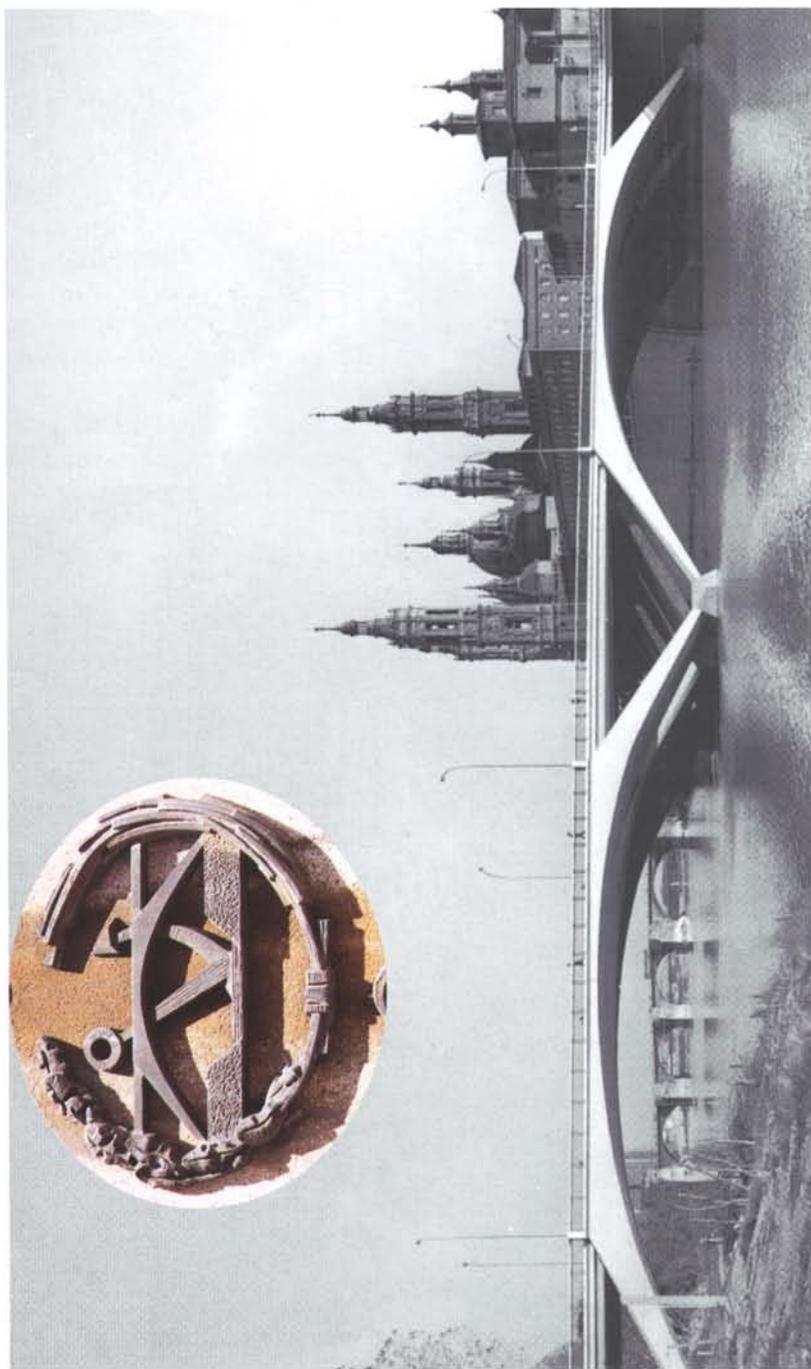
Del puente de sillería al de hormigón pretensado: puente de Santiago (Zaragoza, 1968) y emblema adosado a su pretíl. El emblema reproduce la realización del puente, proclamando una nueva estética y la confianza en las nuevas técnicas de construcción.
